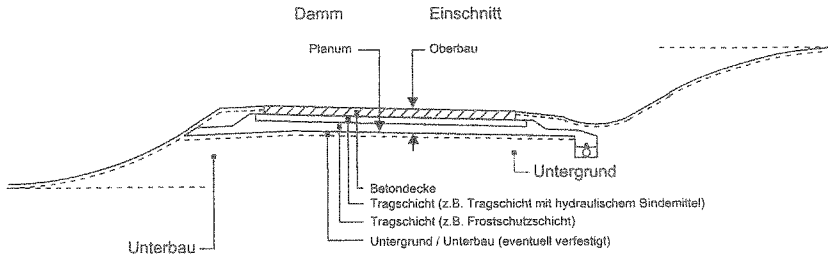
Beispielhafter Aufbau einer Befestigung mit Betondecke außerhalb geschlossener Ortslage im klassifizierten Straßenbau – Damm/Einschnitt
